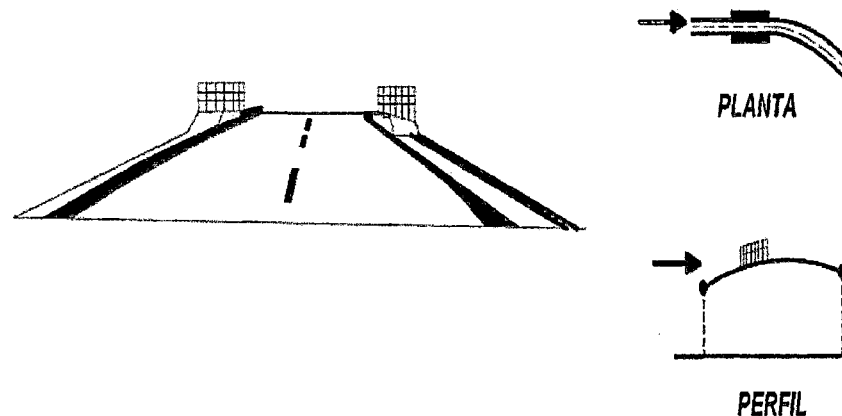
Efectos ópticos por la aparente reducción del ancho de calzada - Fuente[2]
